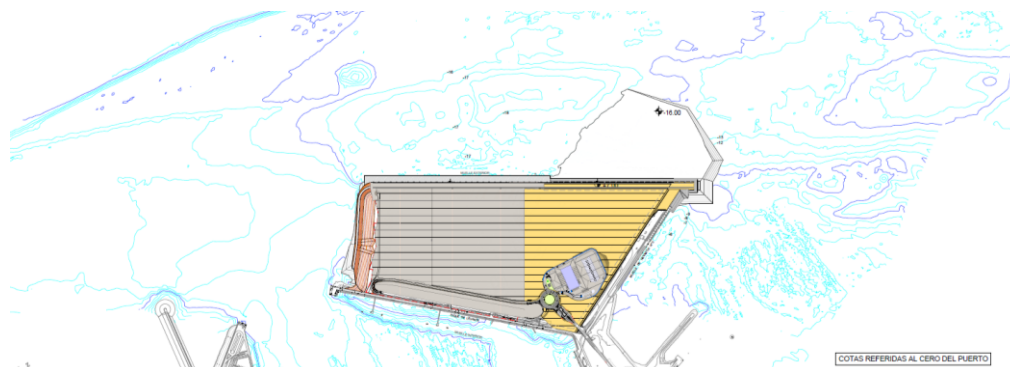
Planta general de la NTC completa, perteneciente al proyecto constructivo de la Fase II. Fuente: APBC
